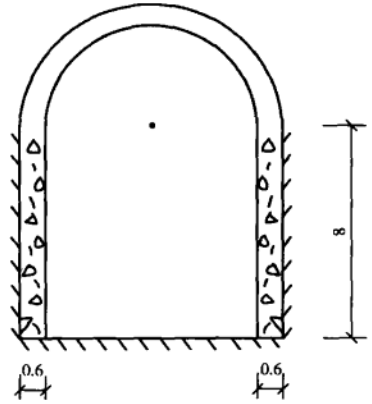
边墙砌筑混凝土示意图 (单位:m)
